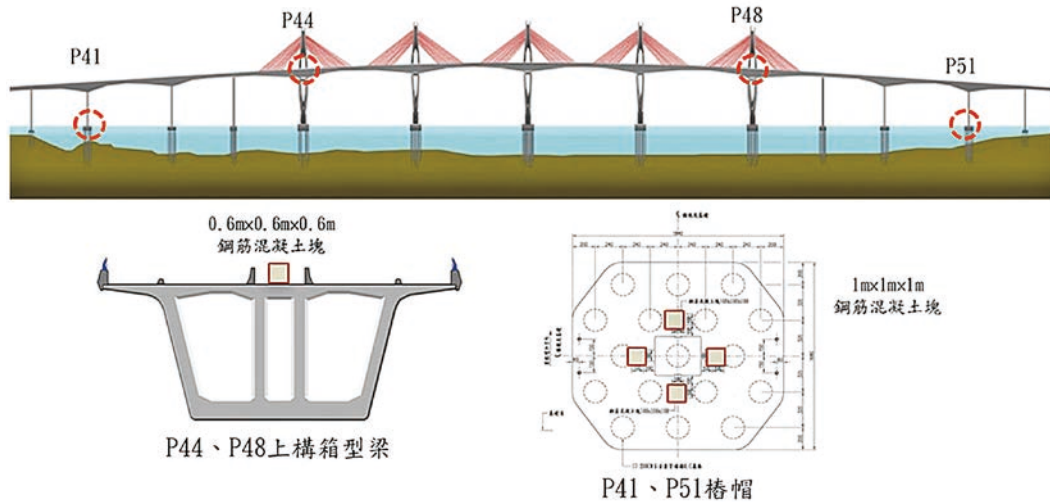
長期鋼筋混凝土材料腐蝕試驗配置示意圖
